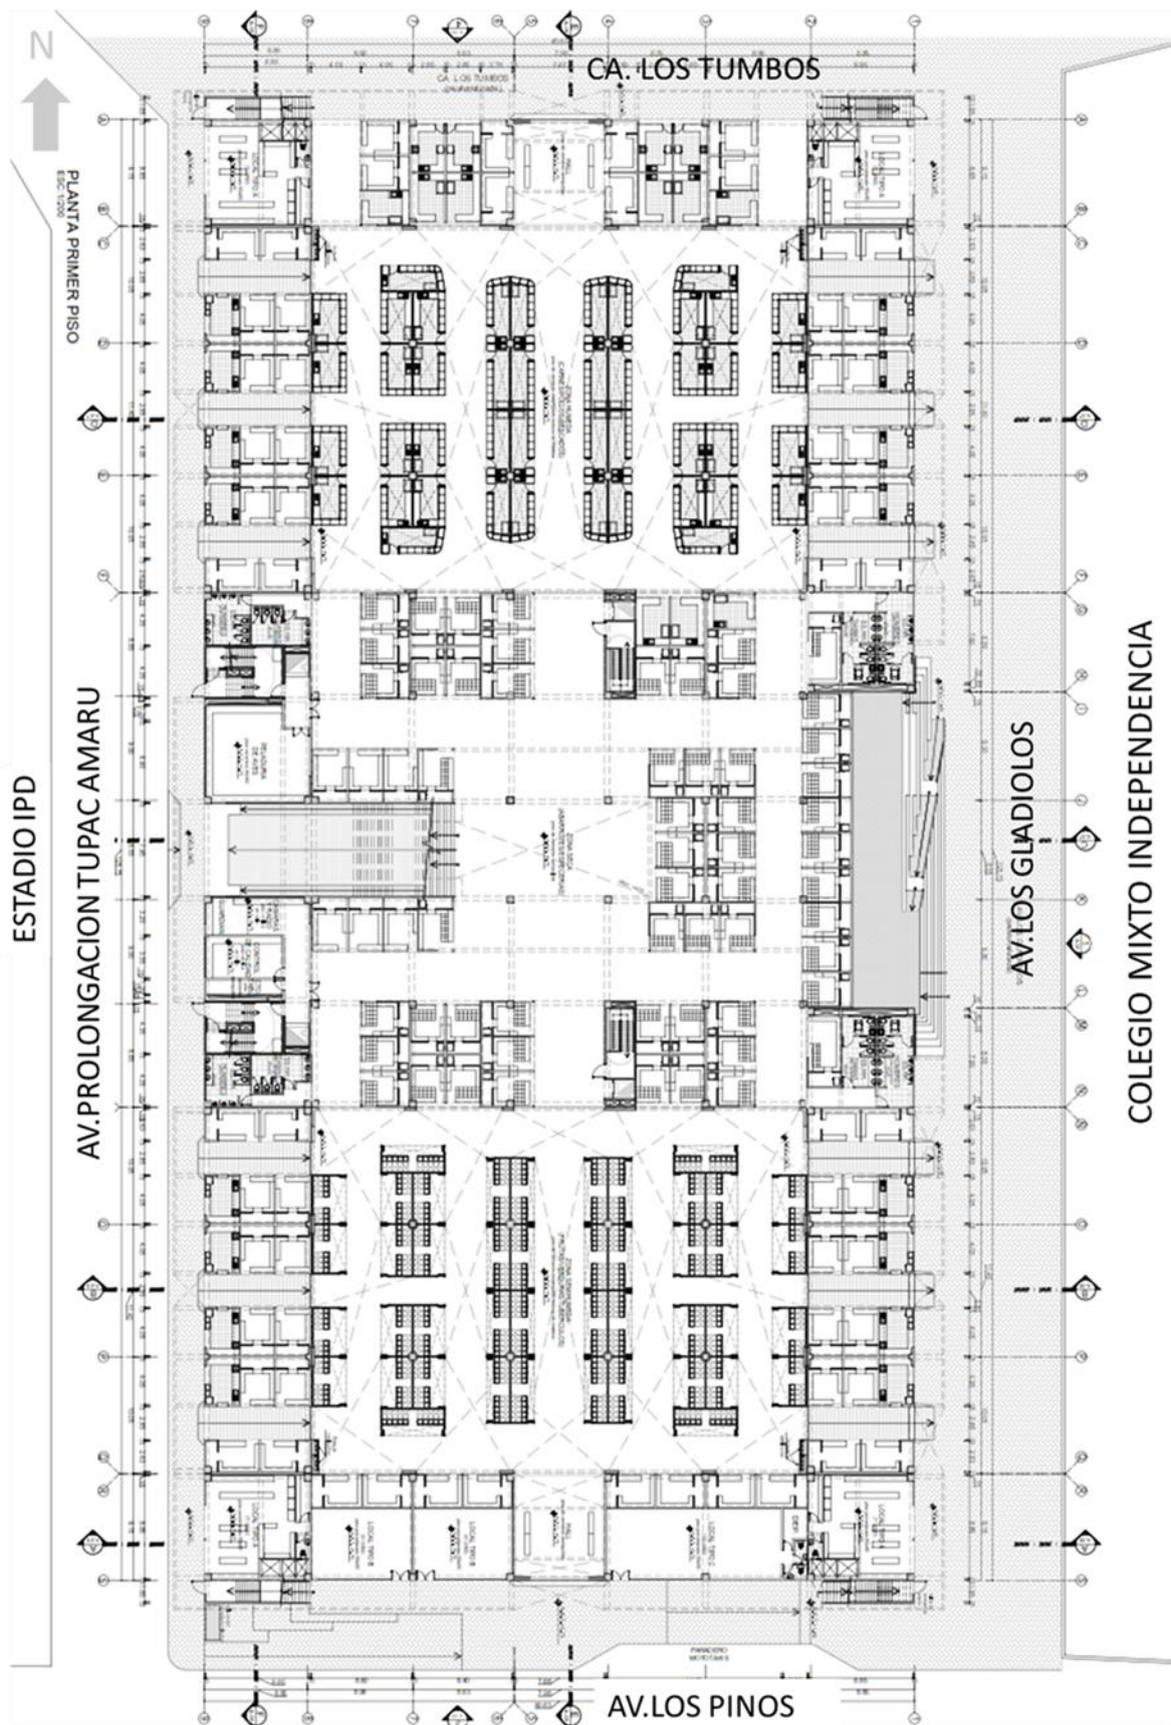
Planta primer piso a nivel de anteproyecto y vías aledañas
